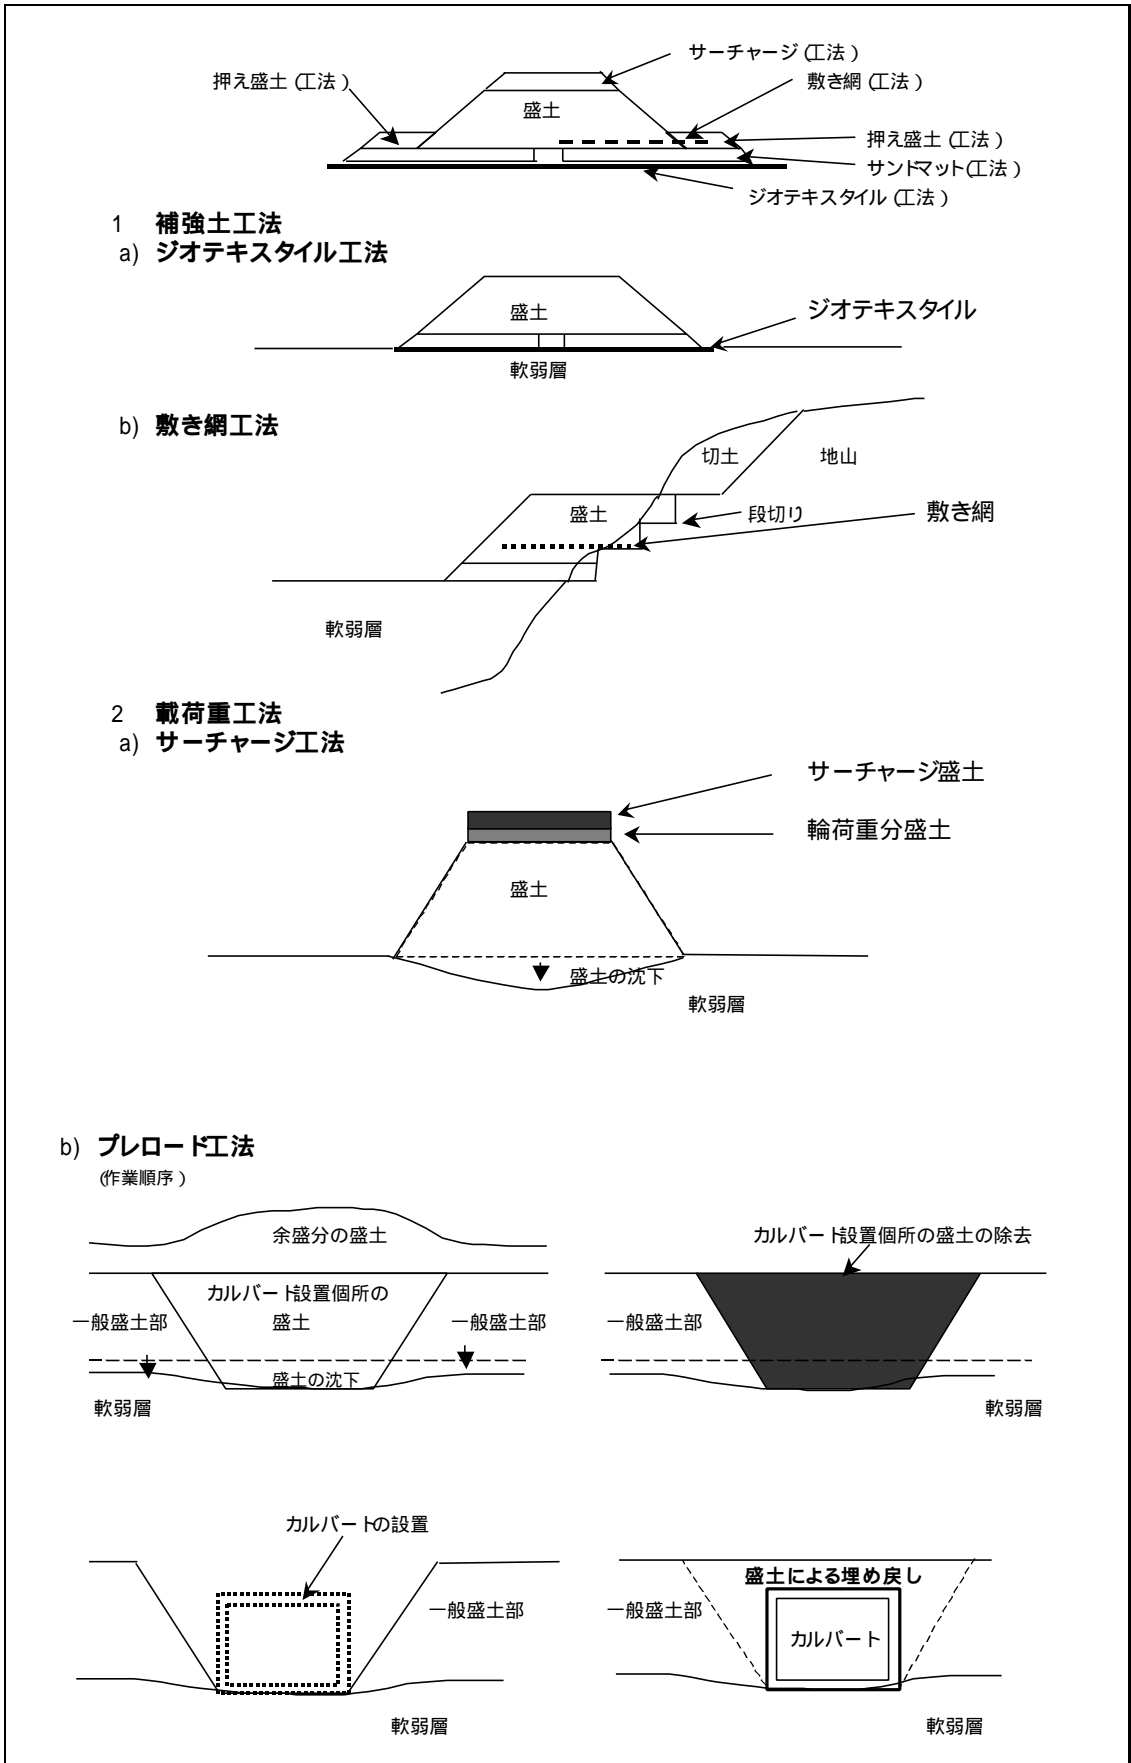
道路盛土の構造と軟弱地盤対策工
